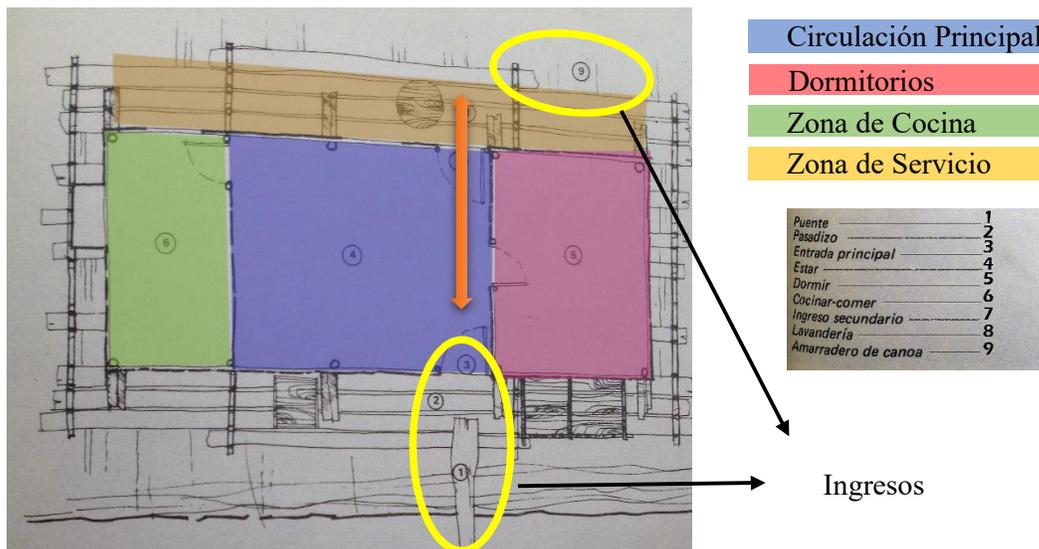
Planta Arquitectónica Vivienda Flotante
